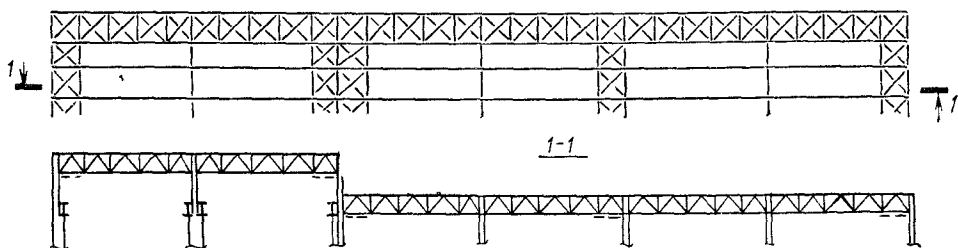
Размещение связей по нижним поясам ферм в многопролетных зданиях
